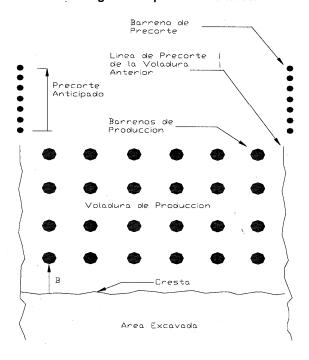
Esquema que muestra una plantilla típica para voladura de pre-corte (vista de planta)
